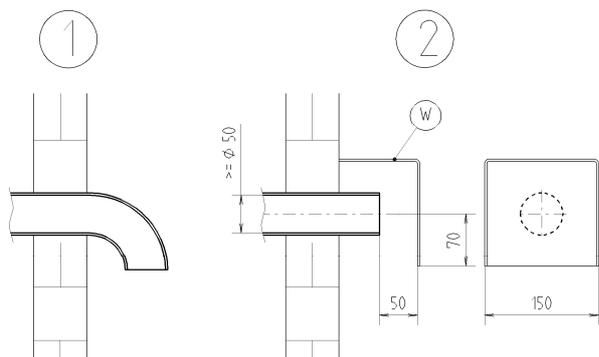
Protection contre le vent du conduit d'aspiration d'air
